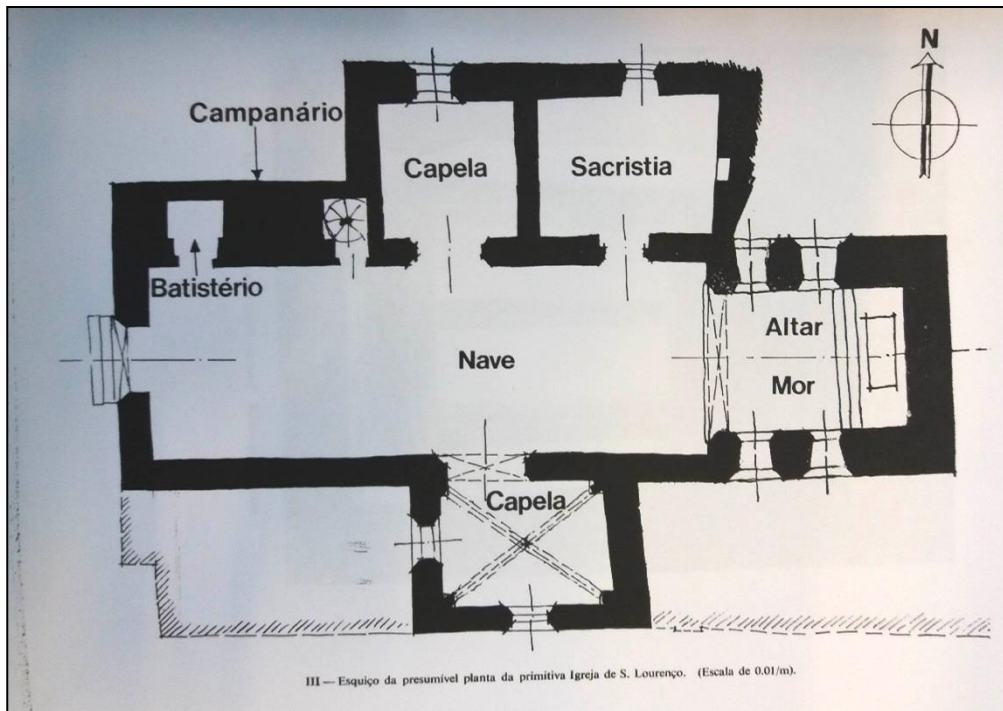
Esboço da planta primitiva da Igreja de São Lourenço. “Escala de 0.01/m”.
